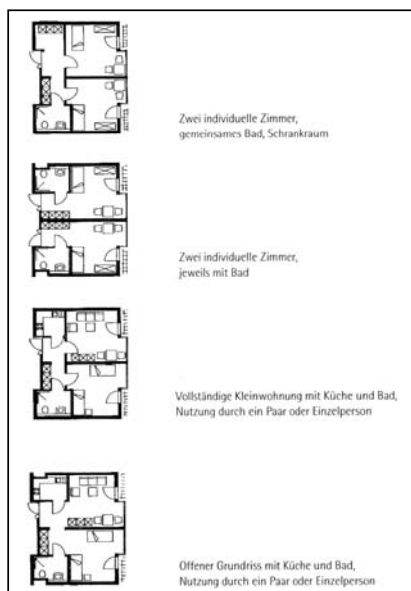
Flexibler Grundriss mit modularen Einheiten (Weeber, 2001, S. 148)
